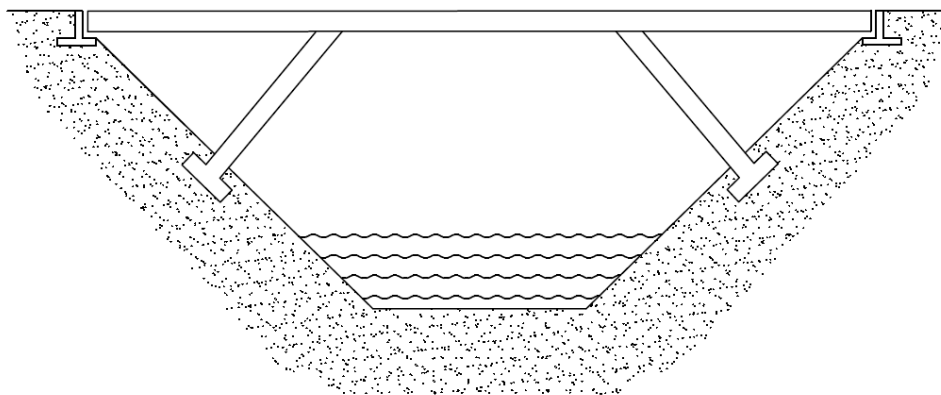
Puente tipo viga continuo con cepas diagonales.
